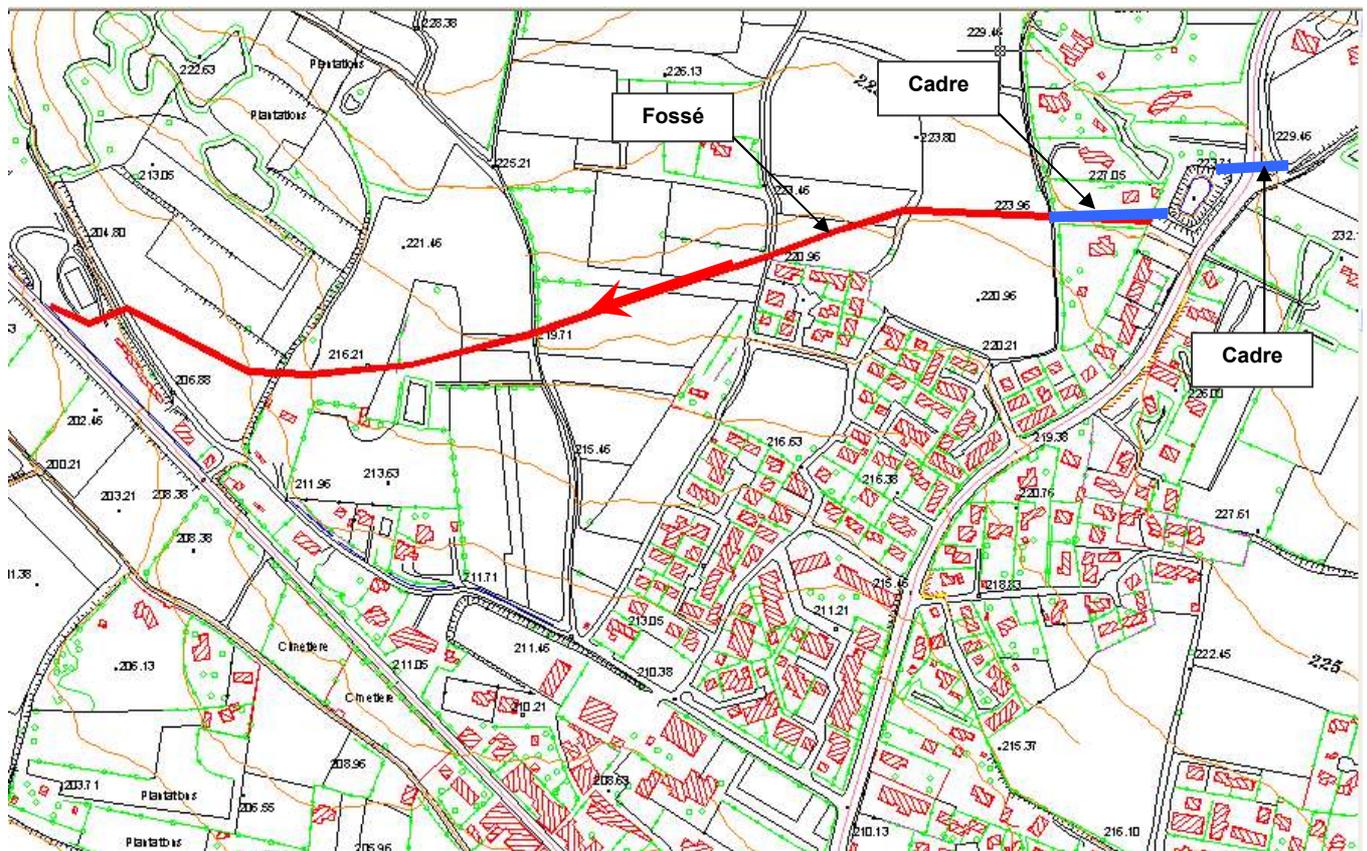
AMENAGEMENT N°2 – VUE EN PLAN
